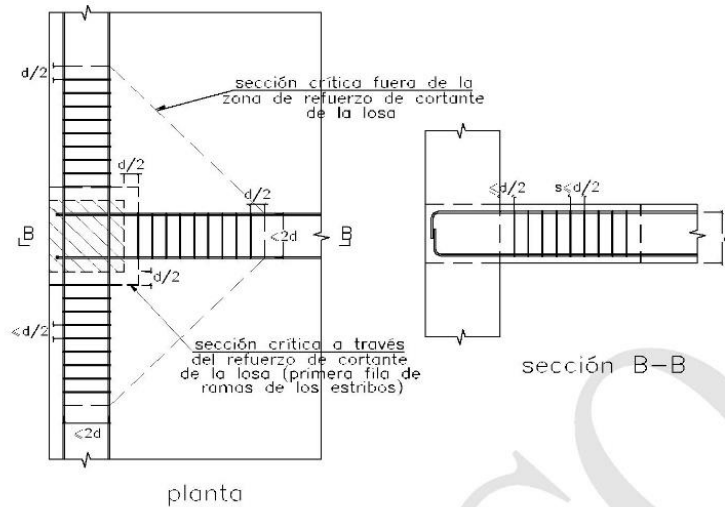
b Disposición de los estribos por cortante en columnas de borde.
